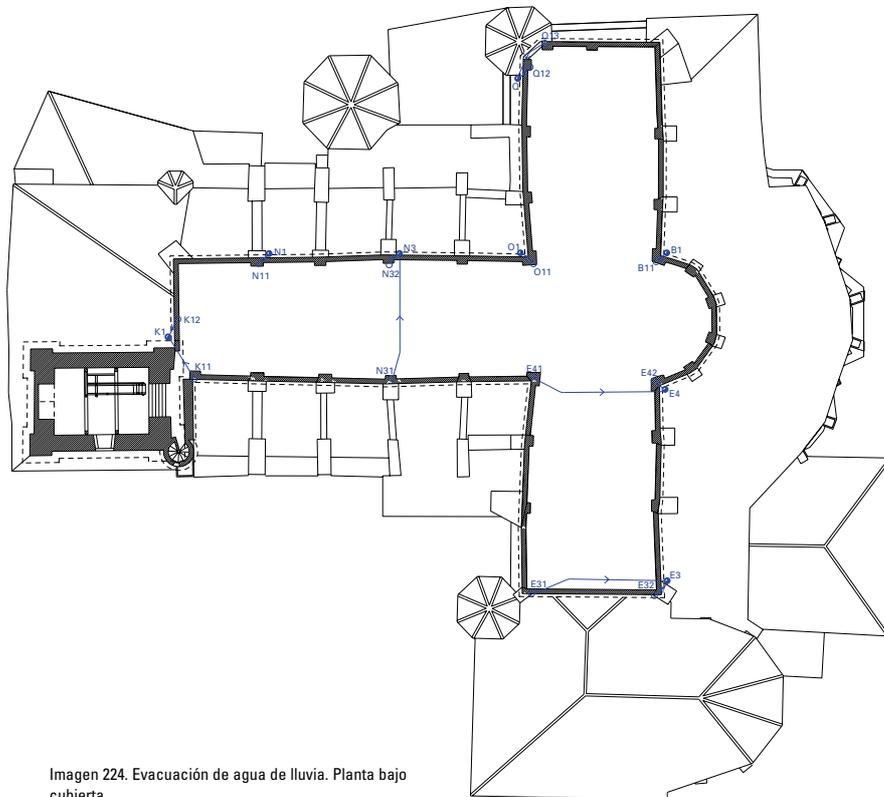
Evacuación de agua de lluvia. Planta bajo cubierta
